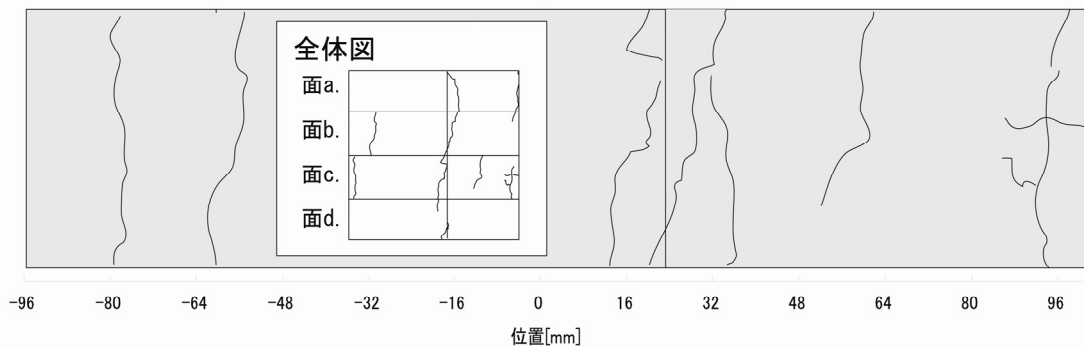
普通コンクリートのひび割れ図-4t 載荷時- (4面を重ねて表示・中央は全体図)
